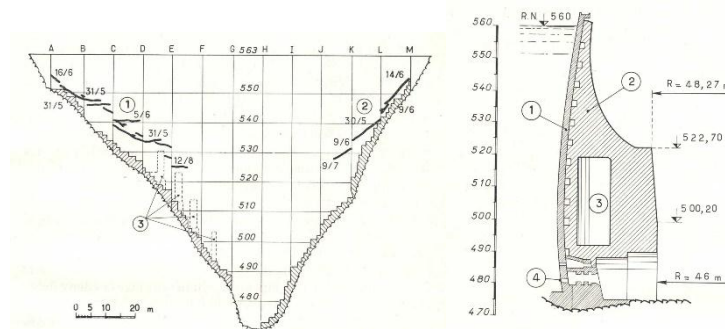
Barrage de Tolla. Localisation des zones de fissuration en parement aval et renforcement aval.
